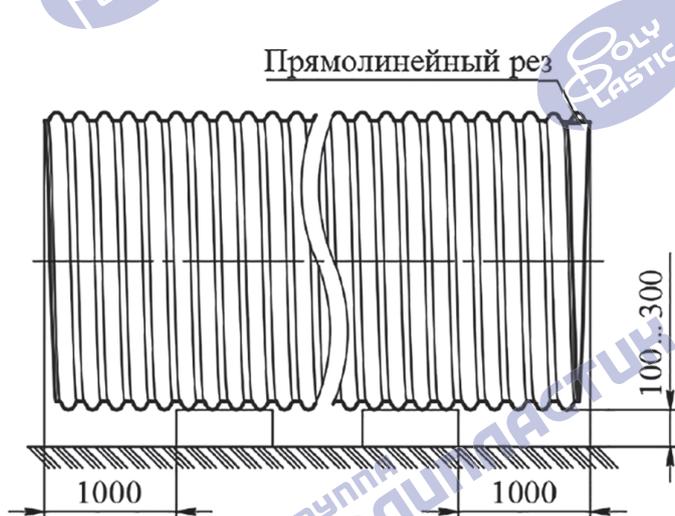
Схема расположения опор для подготовки к монтажу труб «КОРСИС АРМ»
